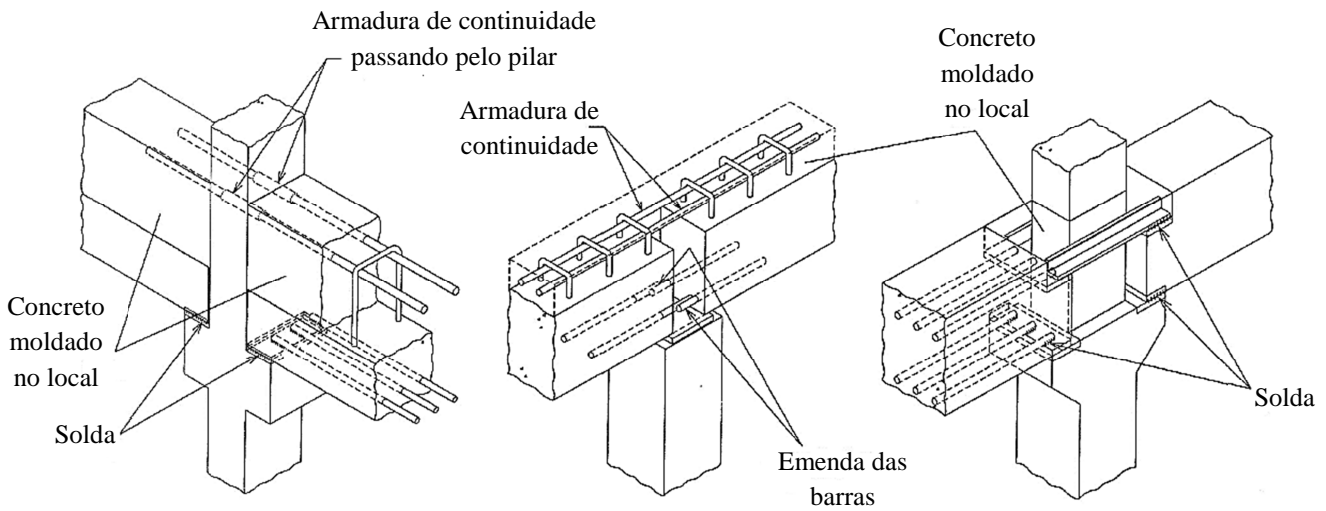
Ligações viga - viga sobre pilar com estabelecimento de continuidade para momento fletor [EL DEBS (2000)].
